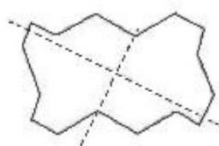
Modelo da peça de concreto para pavimentação ensaiada.
